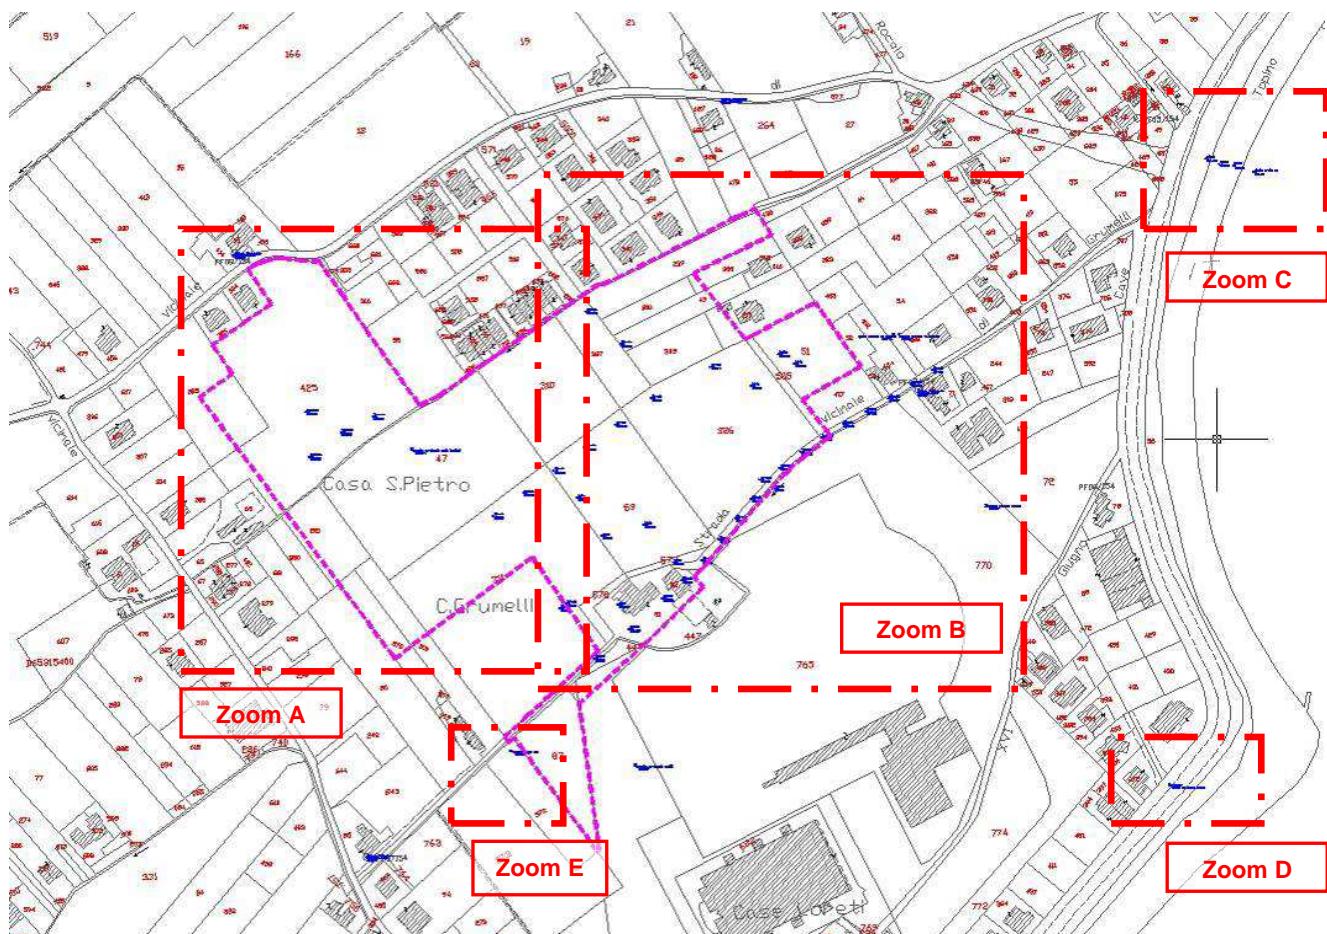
Area oggetto di intervento su Planimetria catastale
